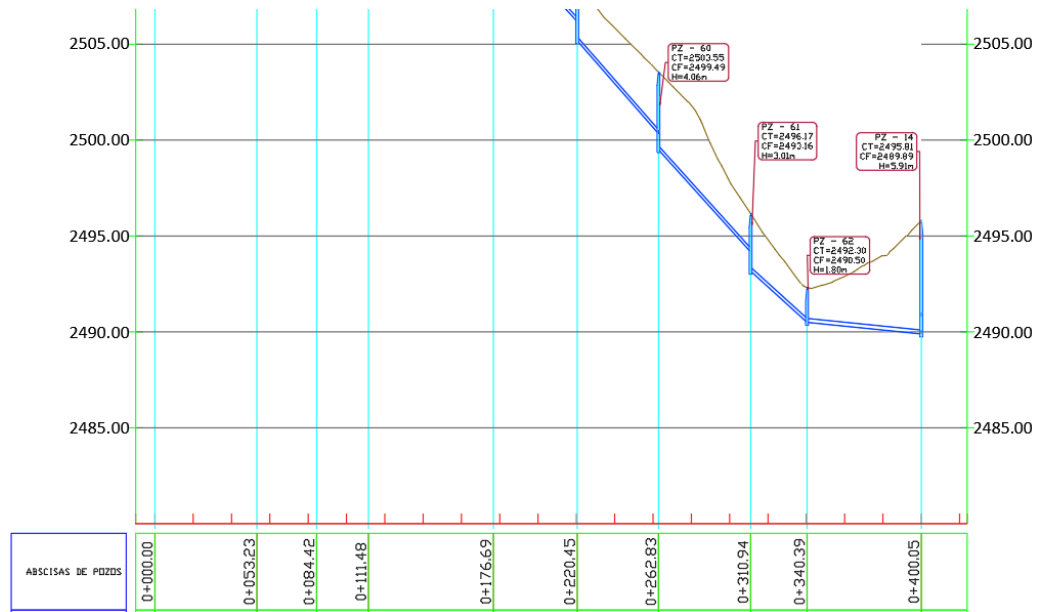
Perfil de red secundaria 7, se detalla el pozo nro. 14.
